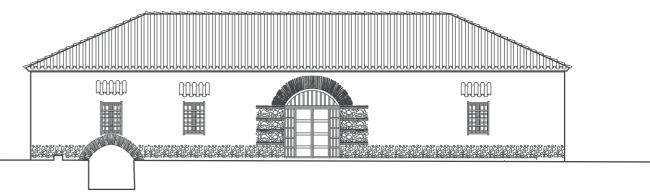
Fachada Molino Losada, Villa de Leyva - Boyacá
